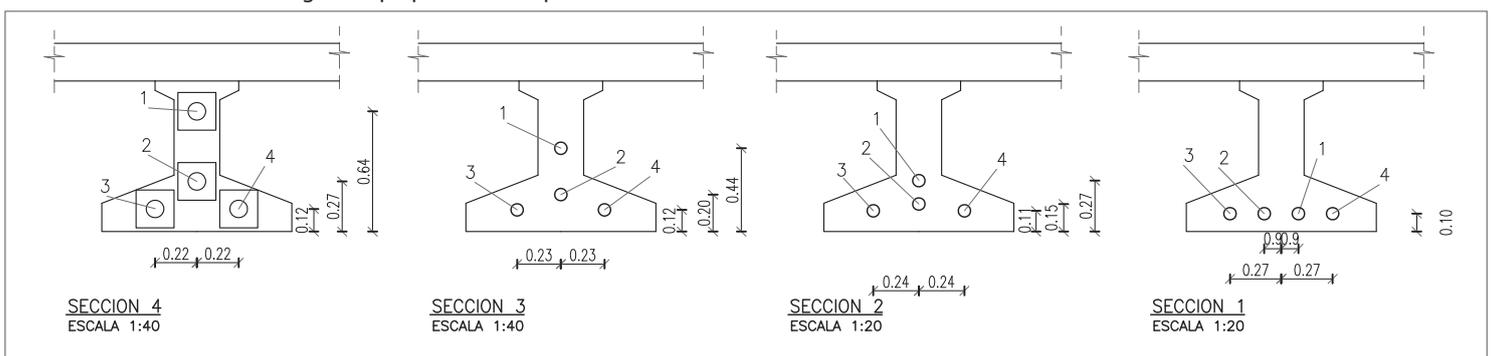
Secciones indicadas en el alzado superior. Escala 1:40 [27]
